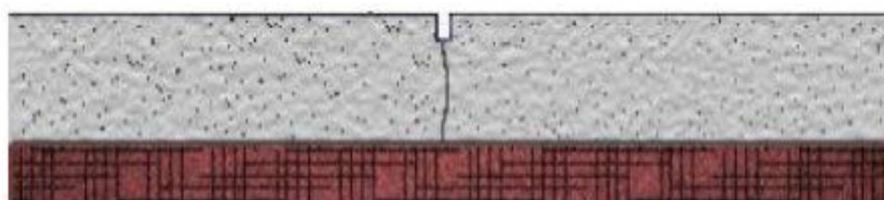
Laje de betão simples (OLIVEIRA, 2000)
